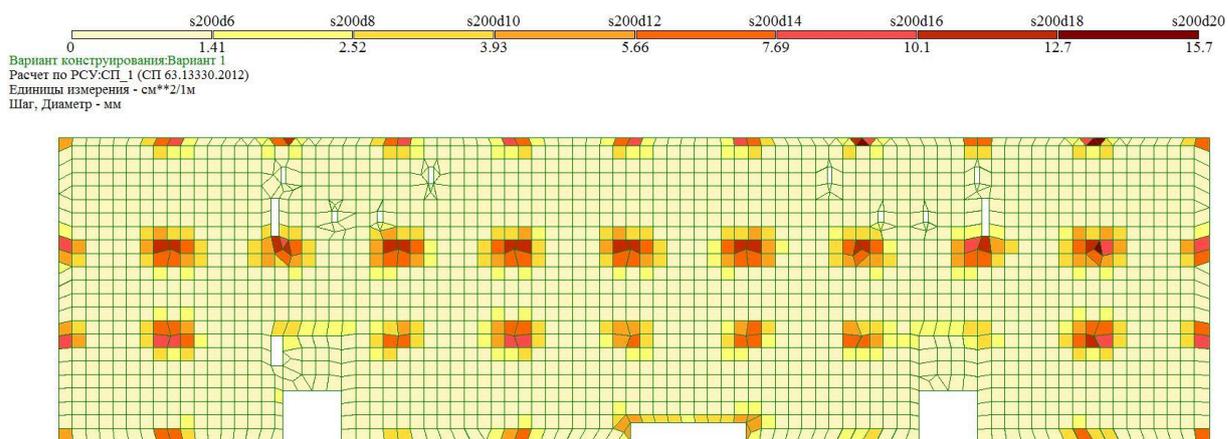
Верхняя арматура в плите перекрытия вдоль оси X
